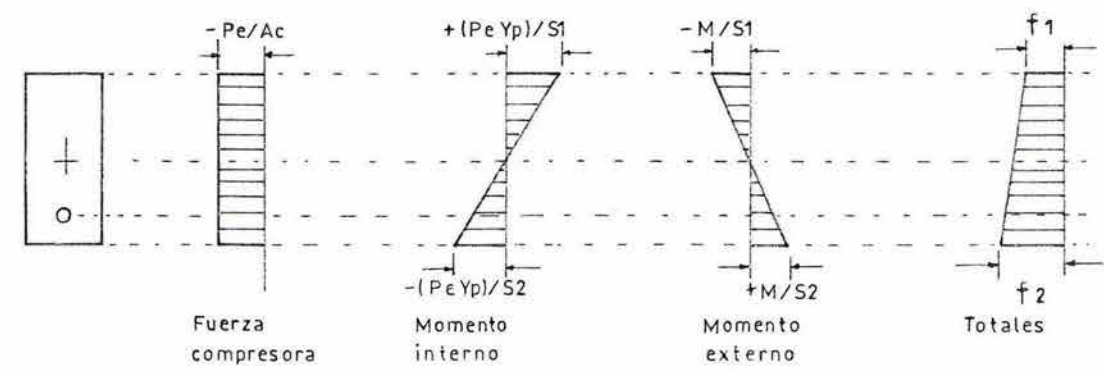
DISTRIBUCION DE ESFUERZOS ATRAVES DE UNA SECCION DE CONCRETO PREESFORZADO EXCENTRICAMENTE.
